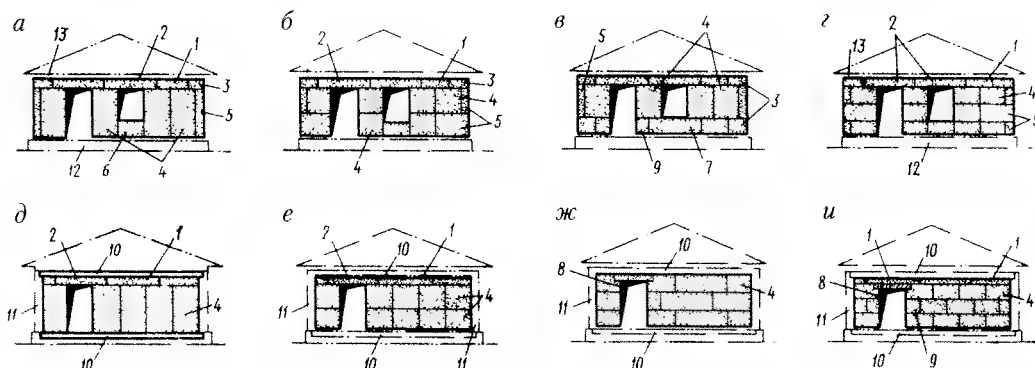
Схемы разрезки стен одноэтажных жилых зданий на крупные блоки: а-г — наружные стены; д-и — внутренние стены (а, д — двухрядная; б, е — трехрядная; в, ж — трехрядная ленточная; г, и — четырехрядная); 1 — поясной рядовой блок; 2 — перемычечный наружный; 3 — поясной угловой; 4 — простеночный рядовой; 5 — простеночный угловой; 6 — подоконный; 7 — поясной нижний; 8 — перемычечный внутренний; 9 — доборный простеночный; 10 — перекрытие; 11 — наружная стена; 12 — цоколь; 13 — карниз
